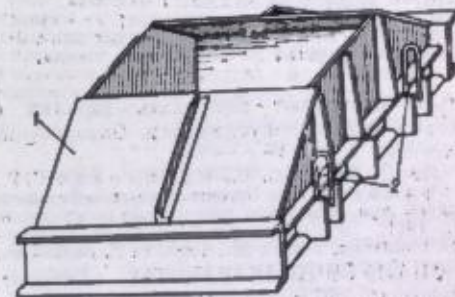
Съемная металлическая форма для изготовления изделия с немедленной распалубкой: 1 — форма; 2 — петли для подъема формы.
